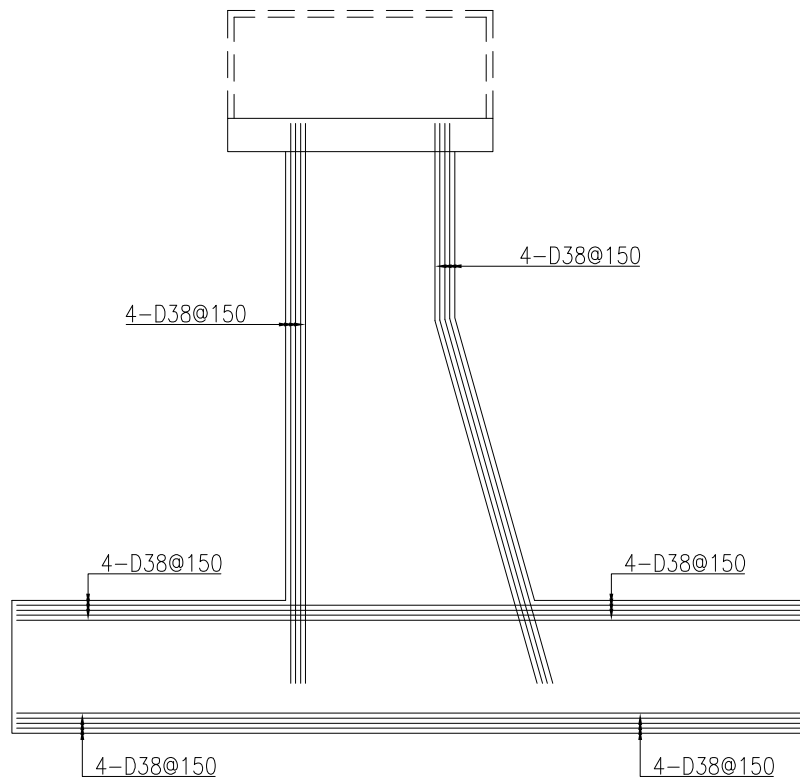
(1) 概略配筋図 (A-A断面)
